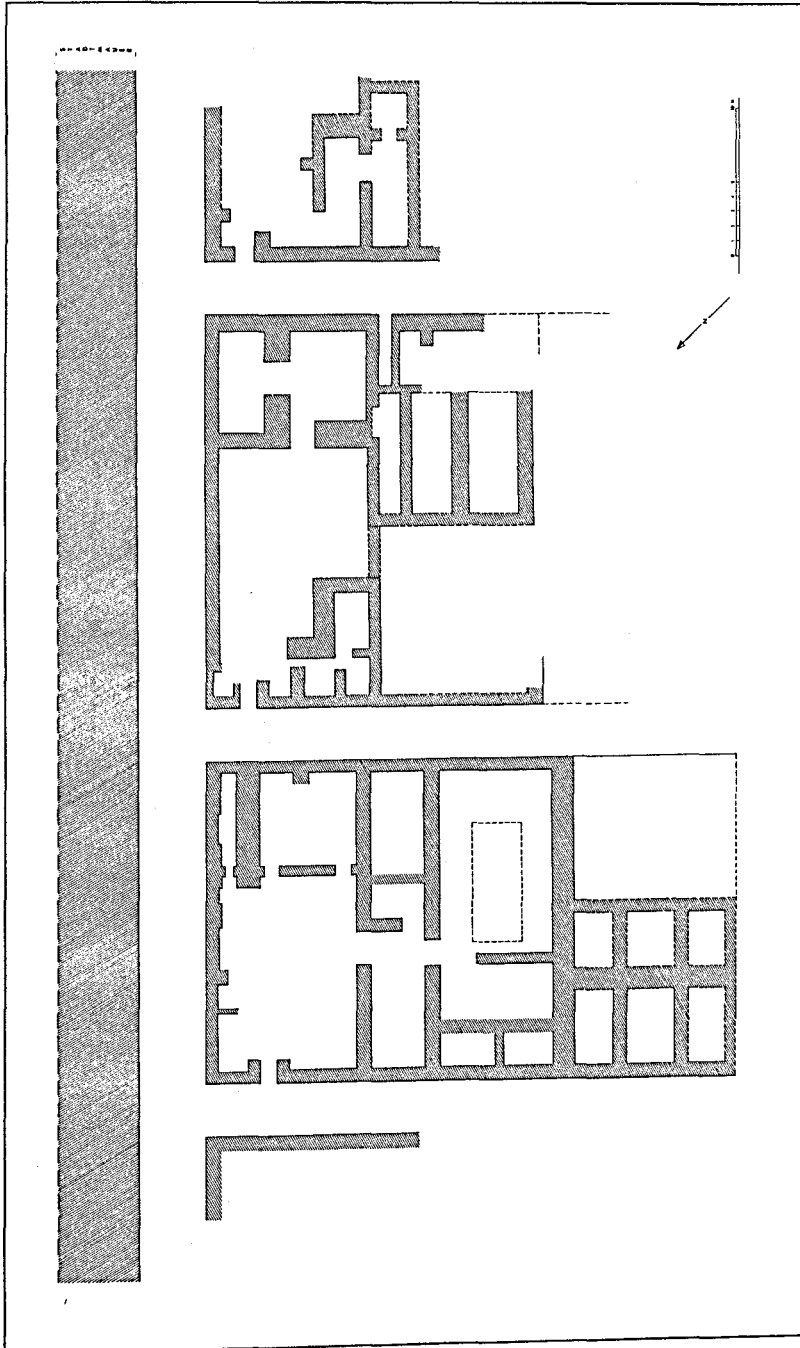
Ruqbat al-Madā'in. Grundrisse an der Stadtmauer
